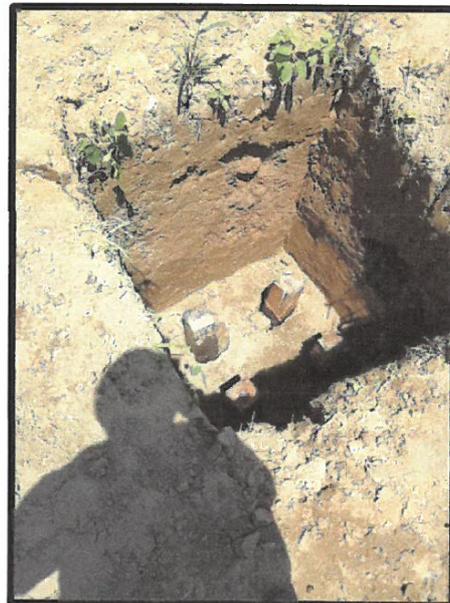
ZAPATA Z-1 EN EL EJE 1-C DEL MODULO 4
